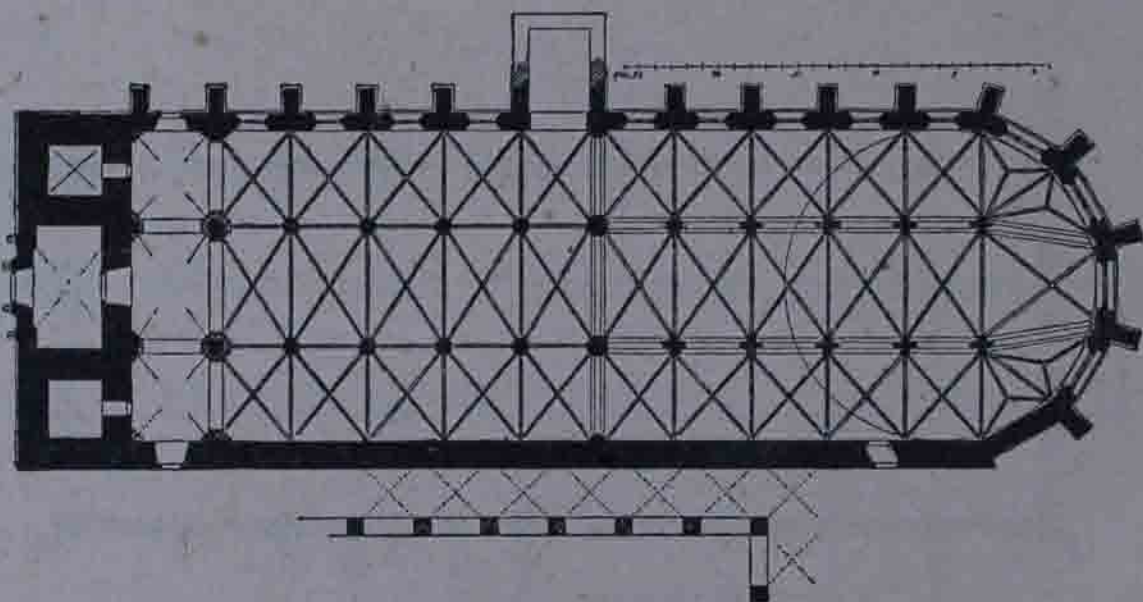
St. Lambrecht, Stiftskirche; Grundriß.
